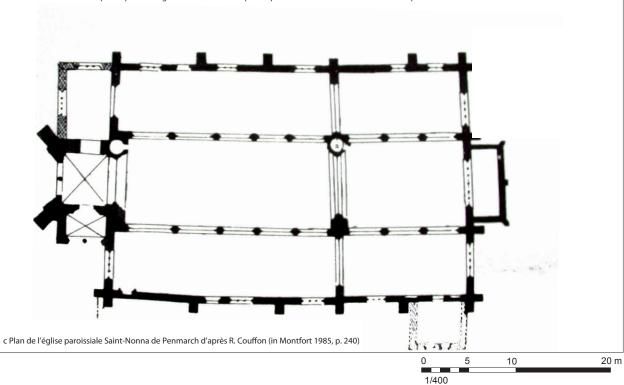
Plan de l'église Saint-Guénolé (suite) © Inrap, Pierre Poilpré
